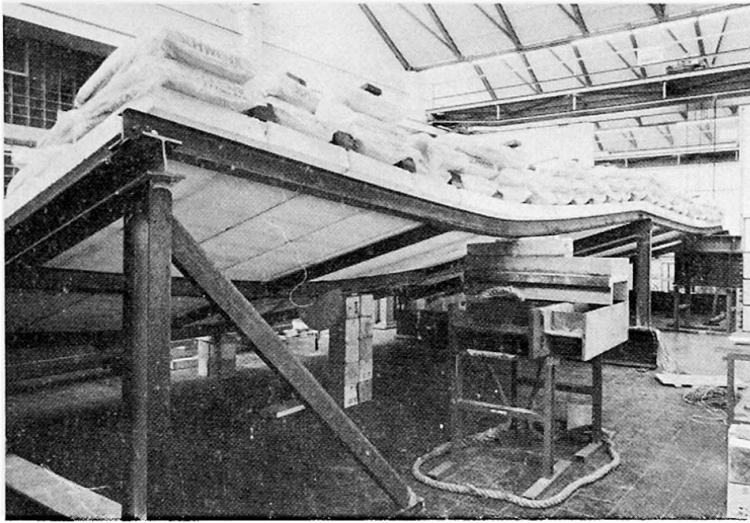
Versuch mit Gasbetonplatten; Pfette IPE 120 über 2 x 6,50 m gestützt; Druckstreben in den Drittelpunkten; Dachneigung 30 % (16,7 °)
